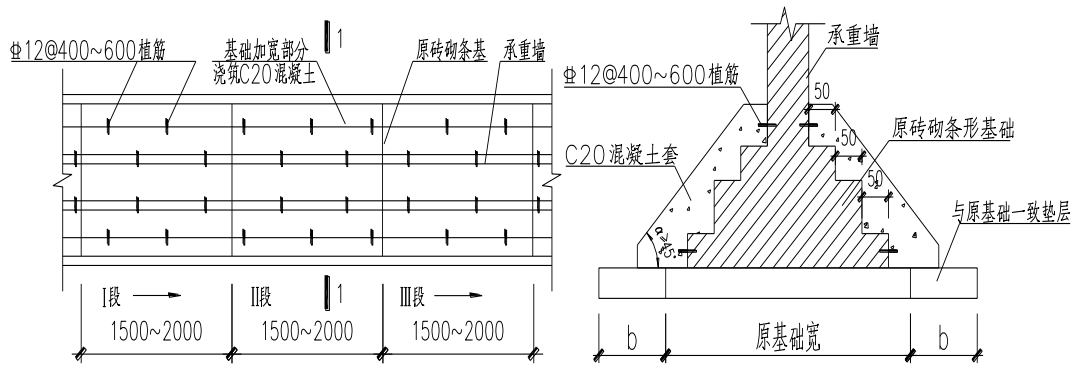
砖砌条形基础混凝土套加宽底面积
